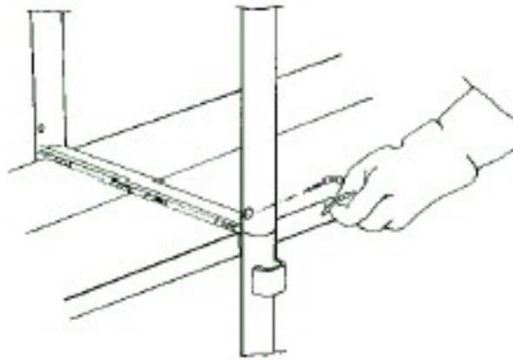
Instalación de la escalera de acceso al nivel superior
